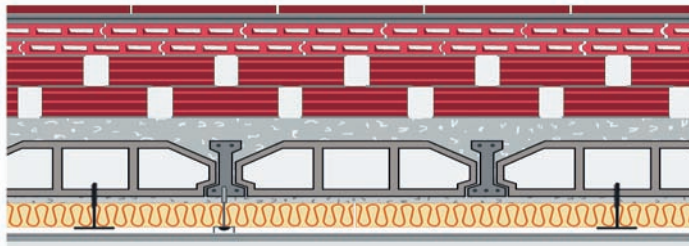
Cubierta plana (azotea) transitable y pavimento sobre tablero cerámico apoyado sobre tabiquillos (cámara de aire).
